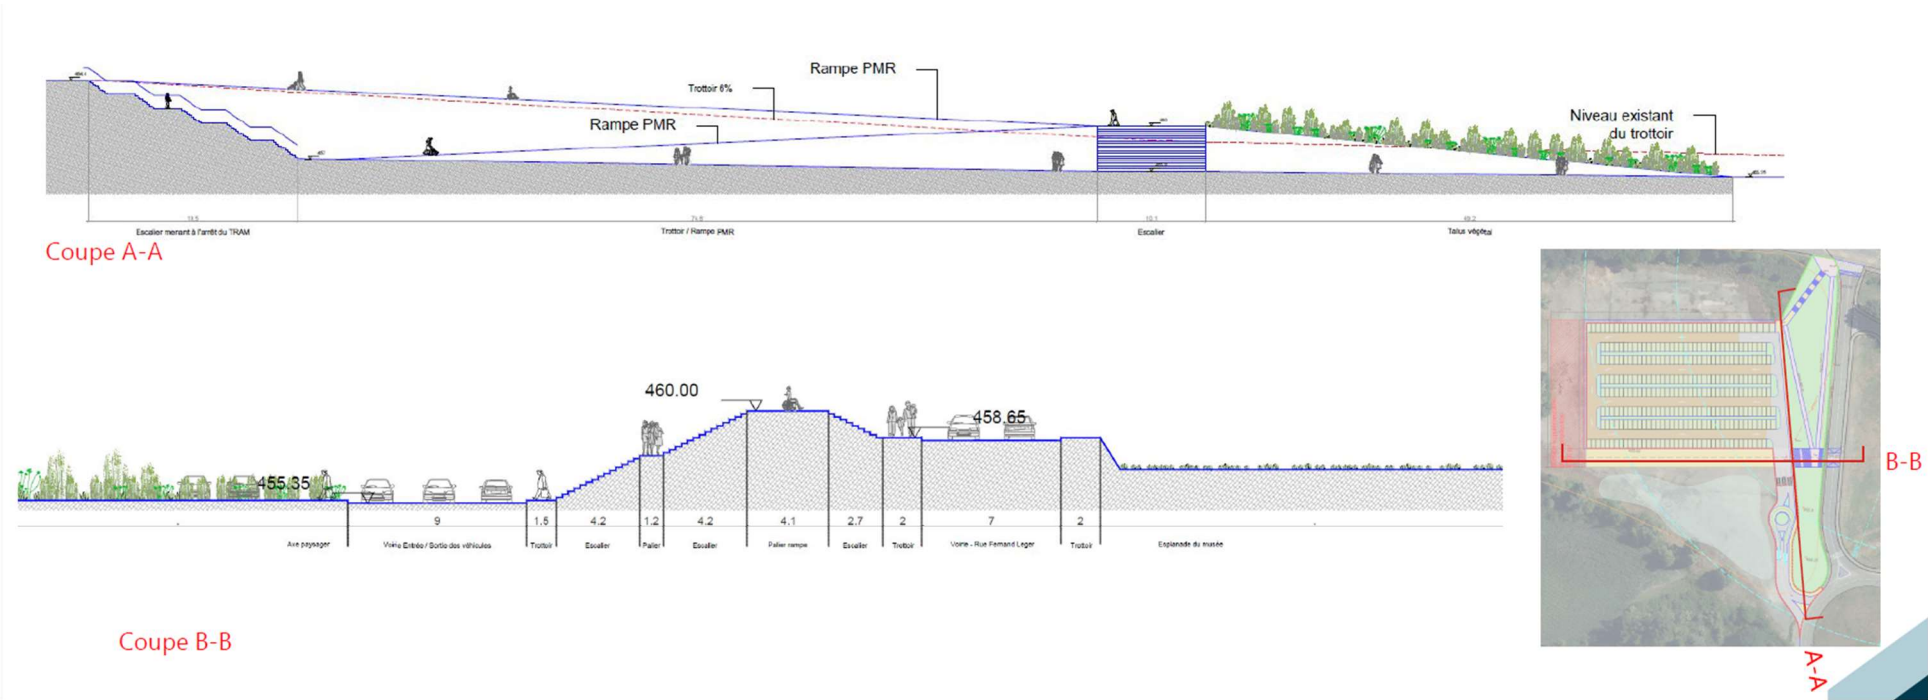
Coupes du profil du projet de parking (Source : EGIS)
